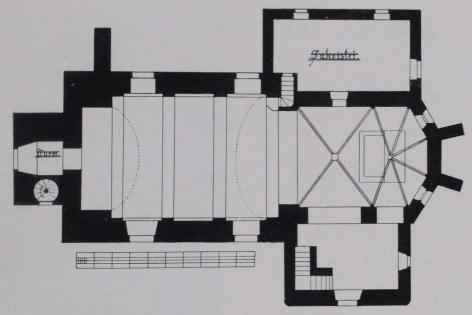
Münichreith, Pfarrkirche, Grundriß 1:200 (S. 36)
